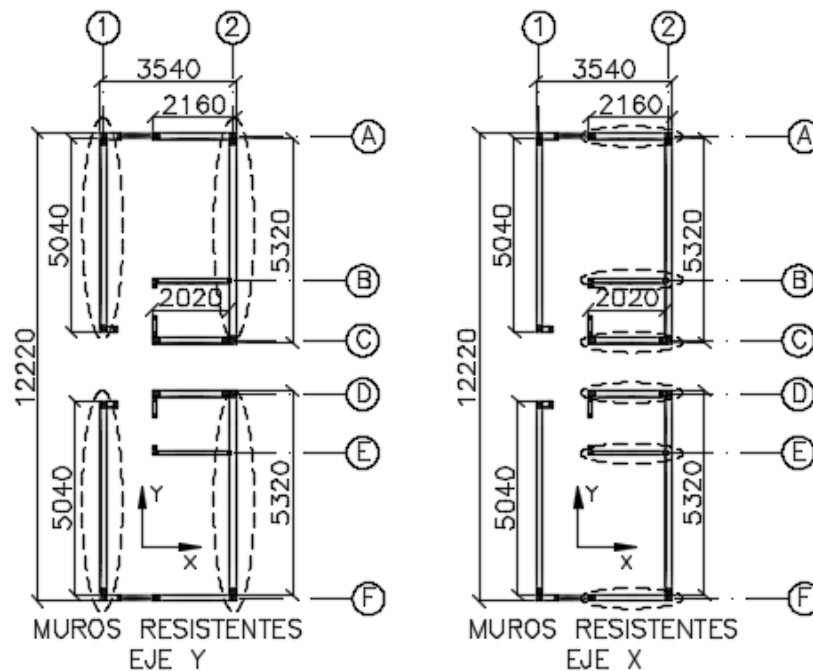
Detalle de estructuración en planta por módulo prefabricado
